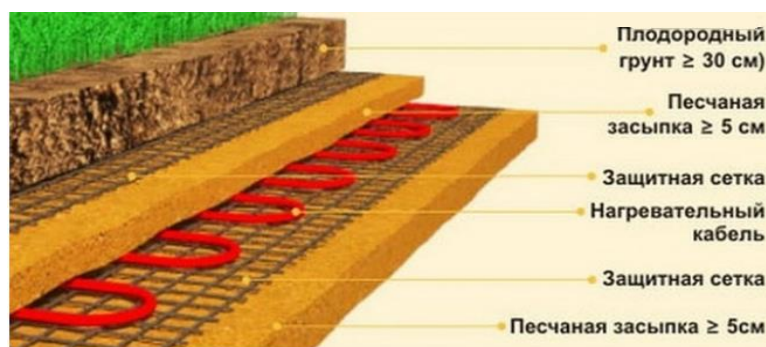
Конструктивный разрез устройства нагревательной системы [2]
